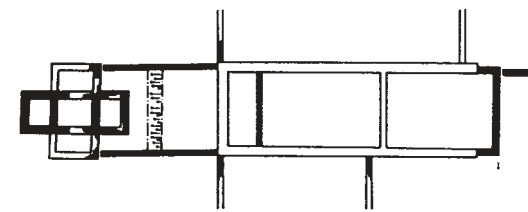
Schuttern, kreuzförmige Kapelle westlich der Klosterkirche, wohl 10. Jahrhundert; Grundriß (Rekonstruktion K. LIST).
